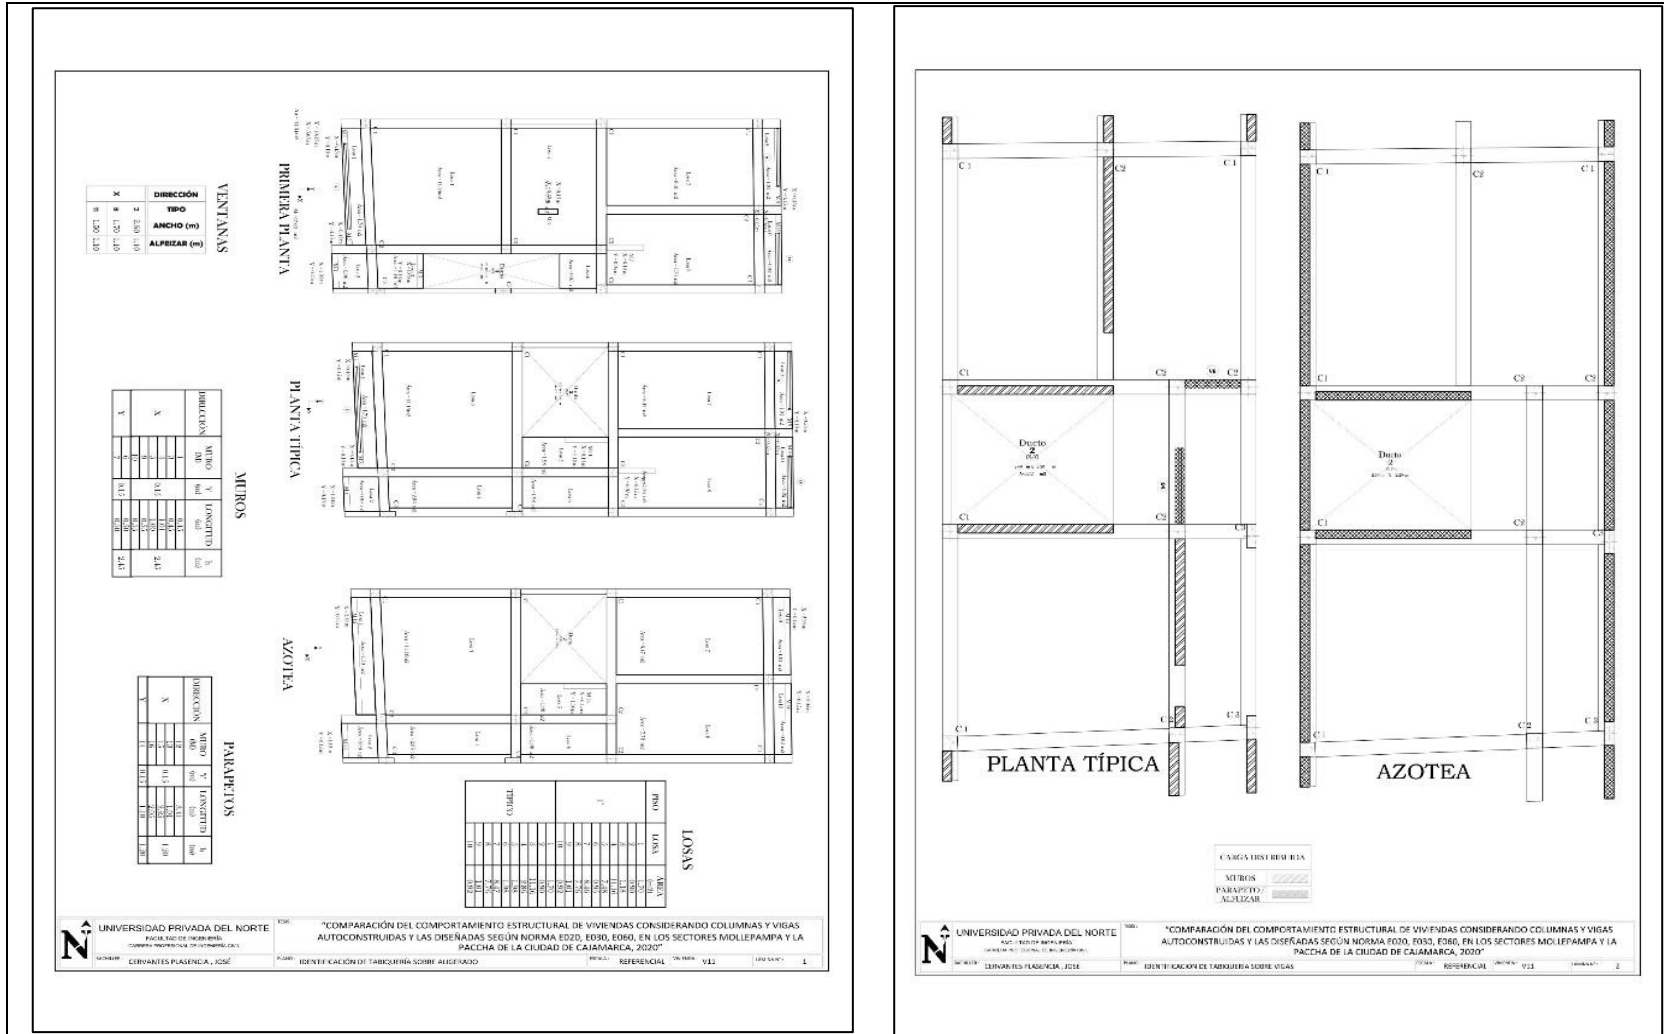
Tabiquería sobre losa aligerada y vigas vivienda 11
